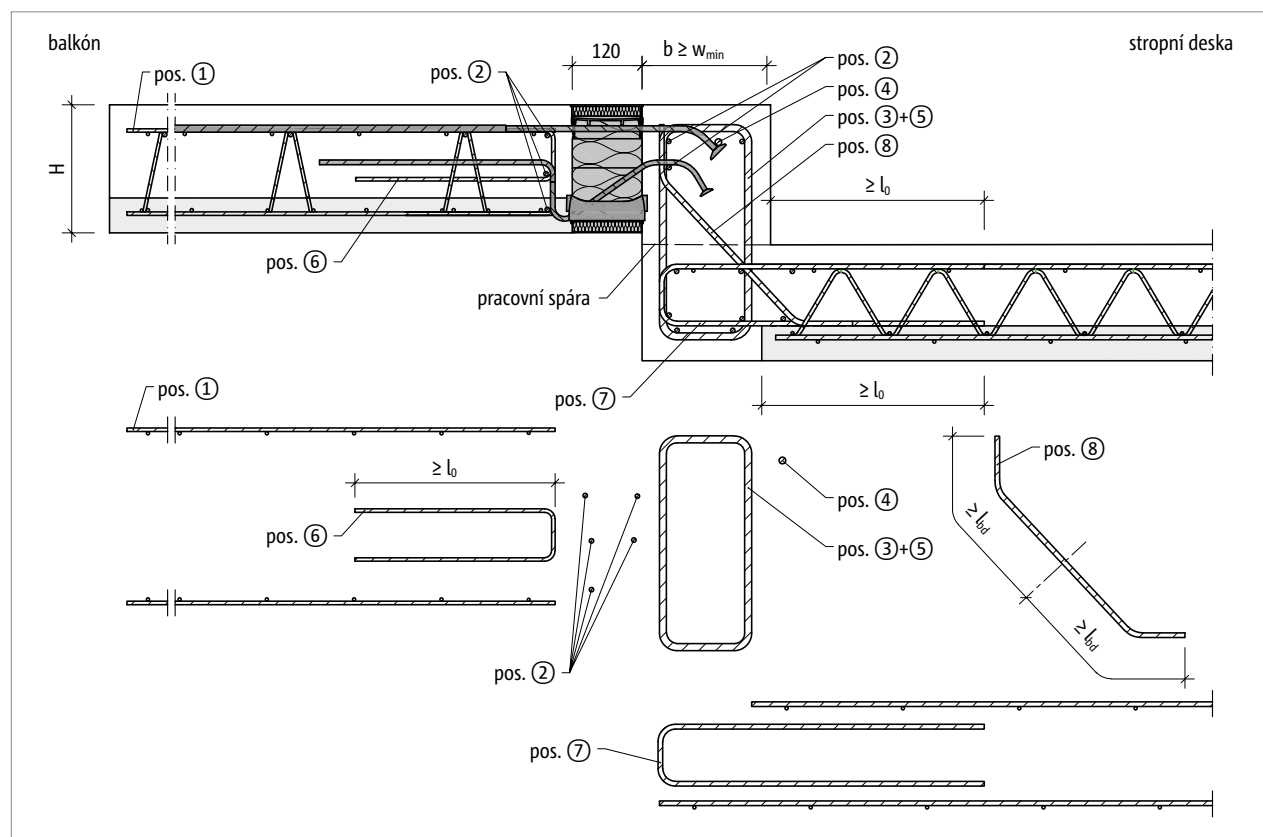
Schöck Isokorb® XT typ KL-O-F: Napojovací stavební výztuž pro balkón nadvýšený oproti stropní desce
